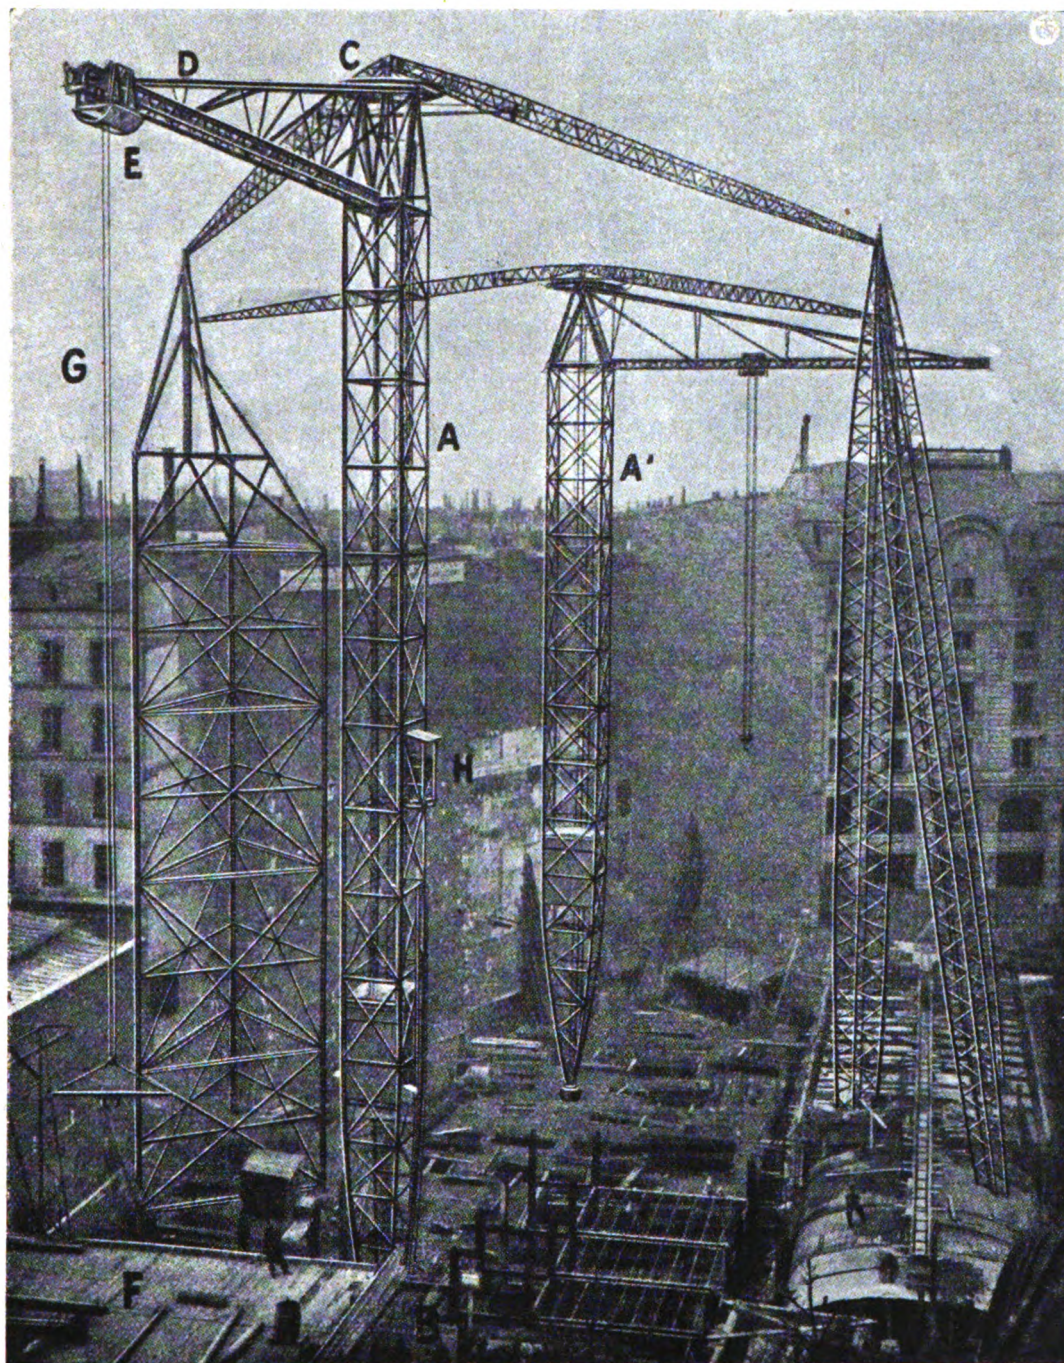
Veduta del cantiere, dal lato del boulevard, servito dalle due torri di ferro congiunte.
